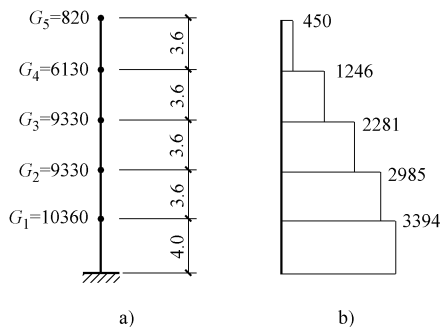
某钢筋混凝土框架结构地震作用计算
